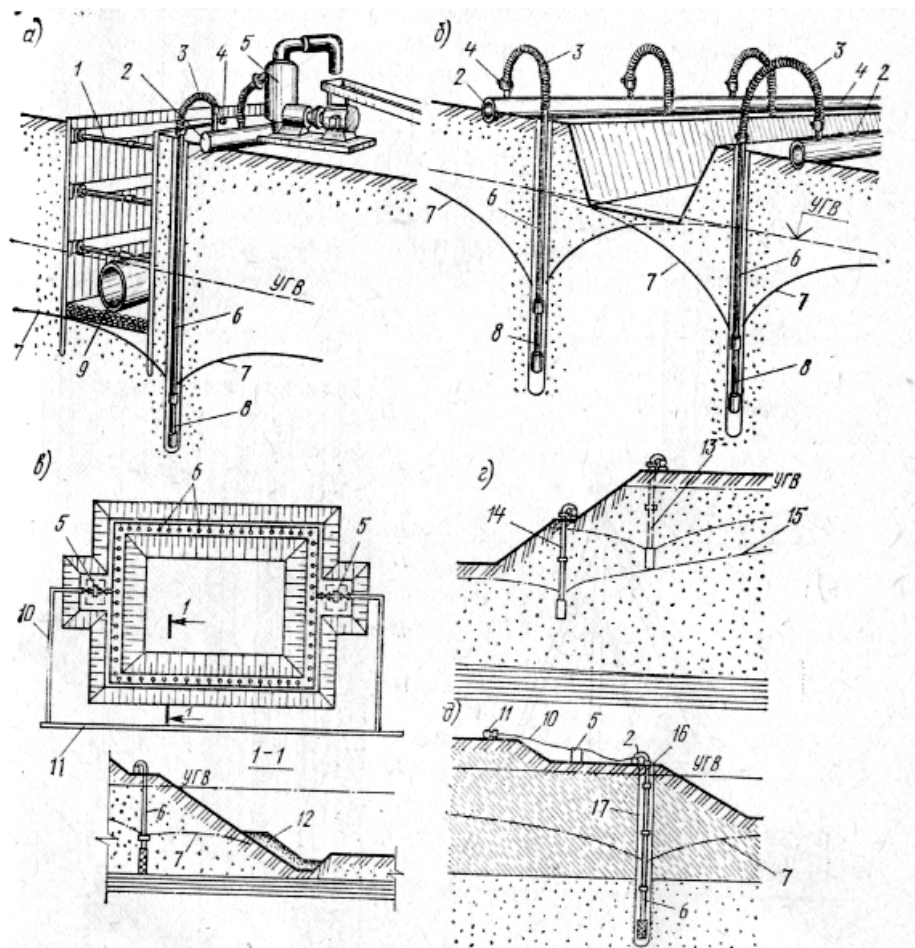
Водопонижение ЛИУ: 1 – траншея с креплениями; 2 – всасывающий коллектор; 3 – соединительные патрубки (шланги); 4 – кран или вентиль; 5 – насосный агрегат; 6 – иглофильтры; 7 – пониженный УГВ; 8 – водоприемное фильтровое звено иглофильтра; 9 – проложенный трубопровод в траншее; 10 – напорный трубопровод; 11 – сборный трубопровод; 12 – дренажная пригрузка; 13 – иглофильтры верхнего яруса; 14 – то же, нижнего яруса; 15 – конечное положение депрессионной поверхности грунтовых вод; 16 – глиняный тампон; 17 – песчано-гравийная обсыпка
